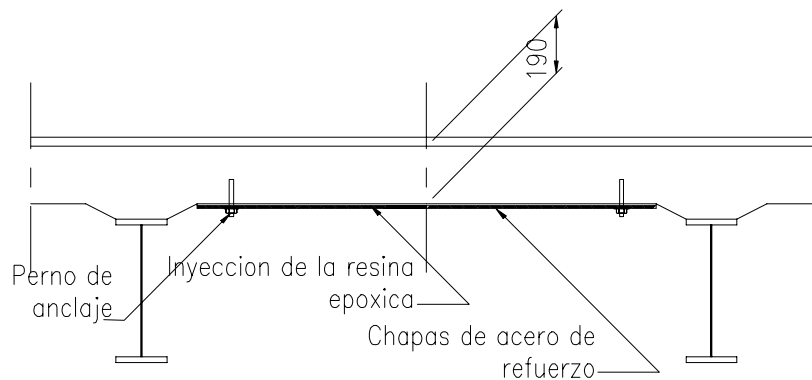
Métodos de refuerzo de losas por la adhesión de planchas de acero
